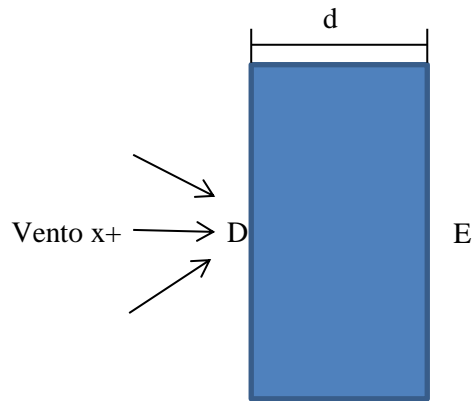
Vista em planta do edifício ilustrando a acção do vento [12]
